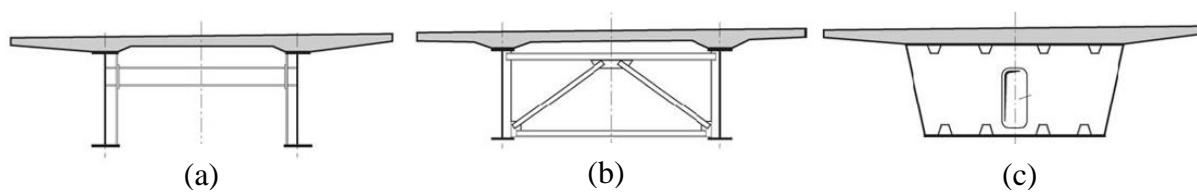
Tipos de Contraventamento Vertical Transversal (retirado de Lebet e Hirt (2013))
